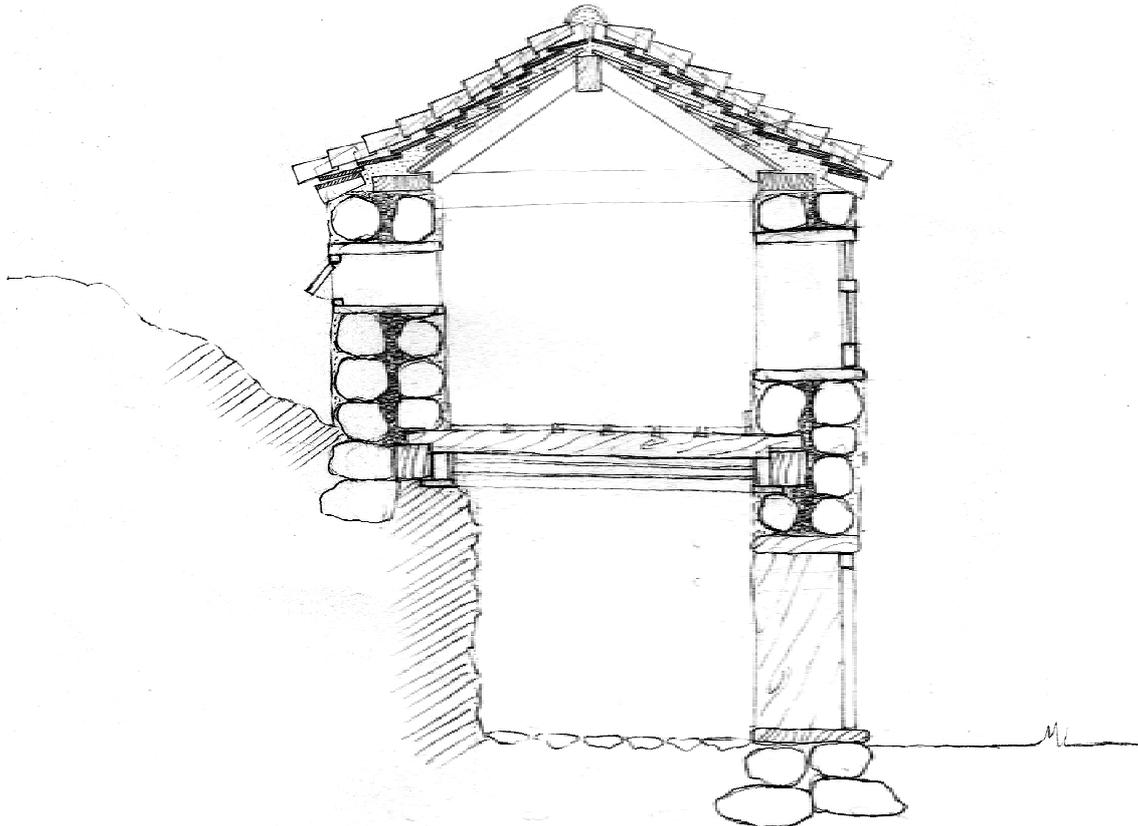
Sección tipo de vivienda de arrimo. Elaboración propia.
